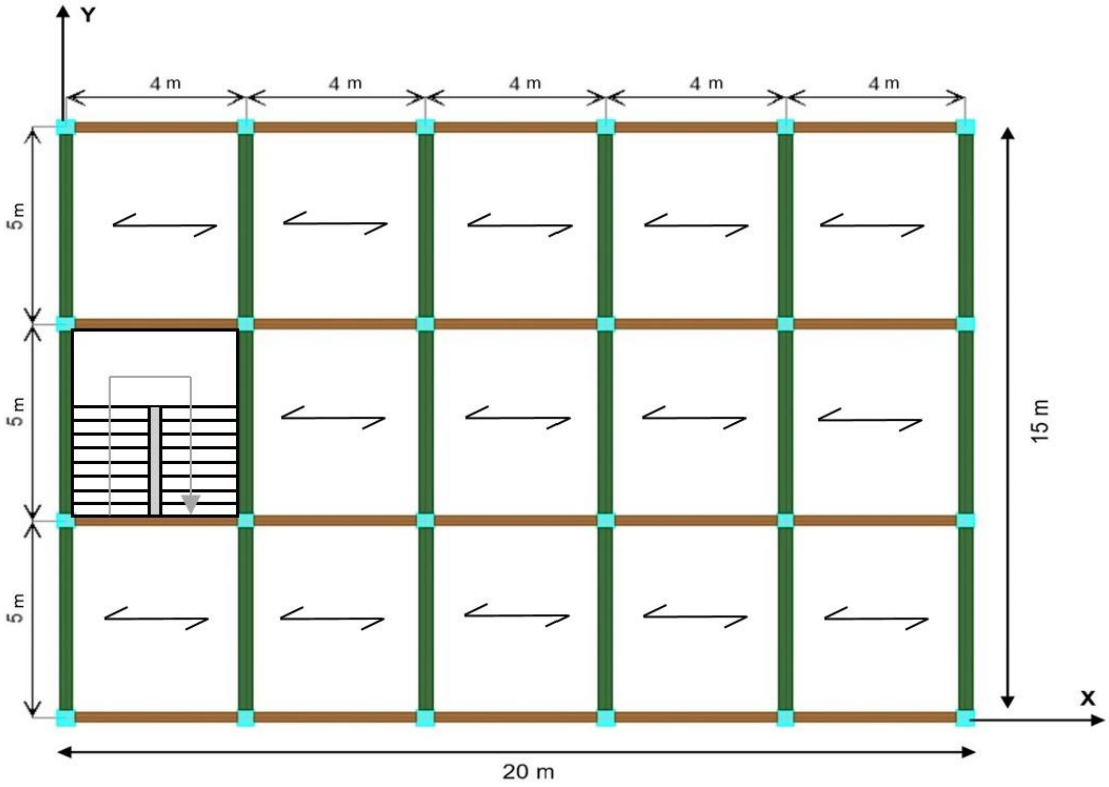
Vue en plan de la structure de type C : escalier positionné à la première travée suivant la direction X-X et à la deuxième travée suivant la direction Y-Y.
